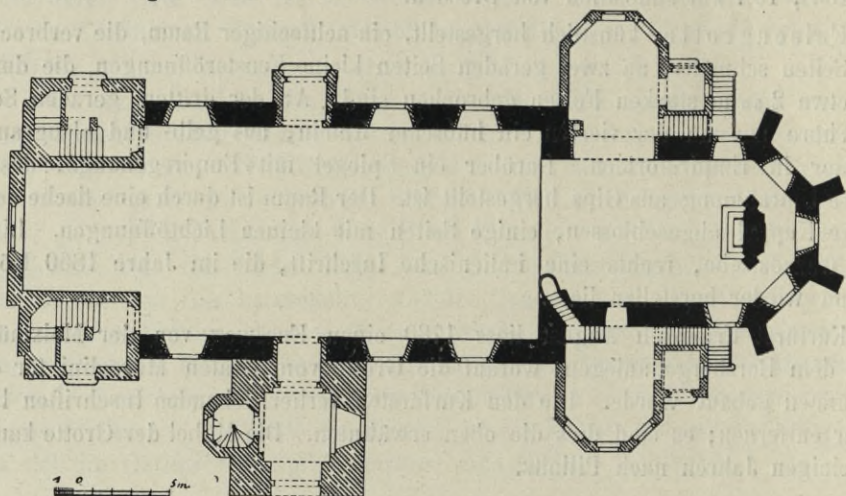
Radeberg, Grundriss der Kirche.
